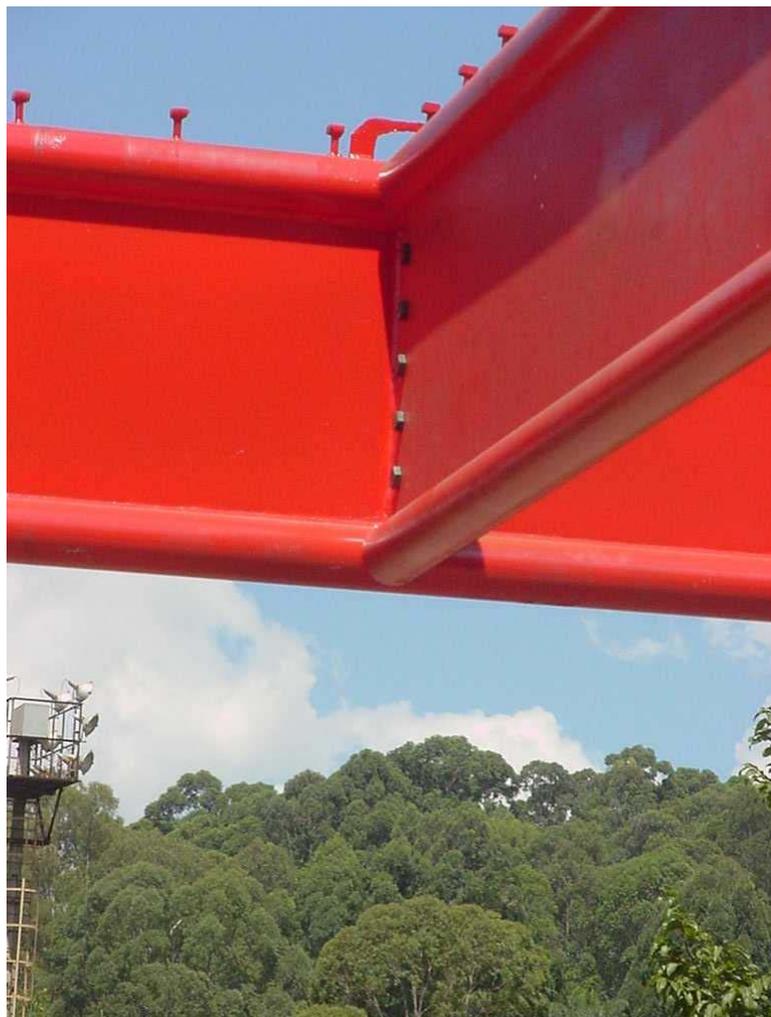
Detalhe da ligação articulada nas vigas de seção composta.
